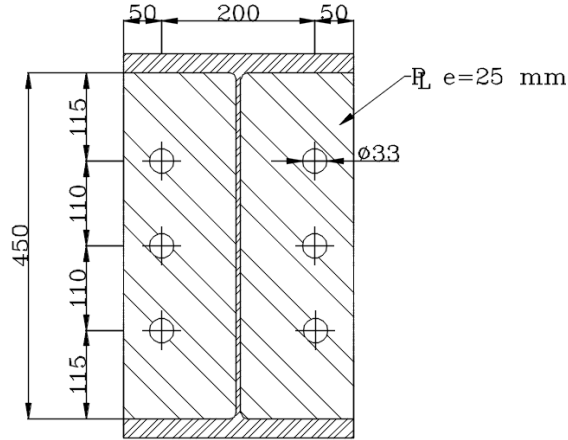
Dibujo de la conexión viga-columna, cotas en mm.
